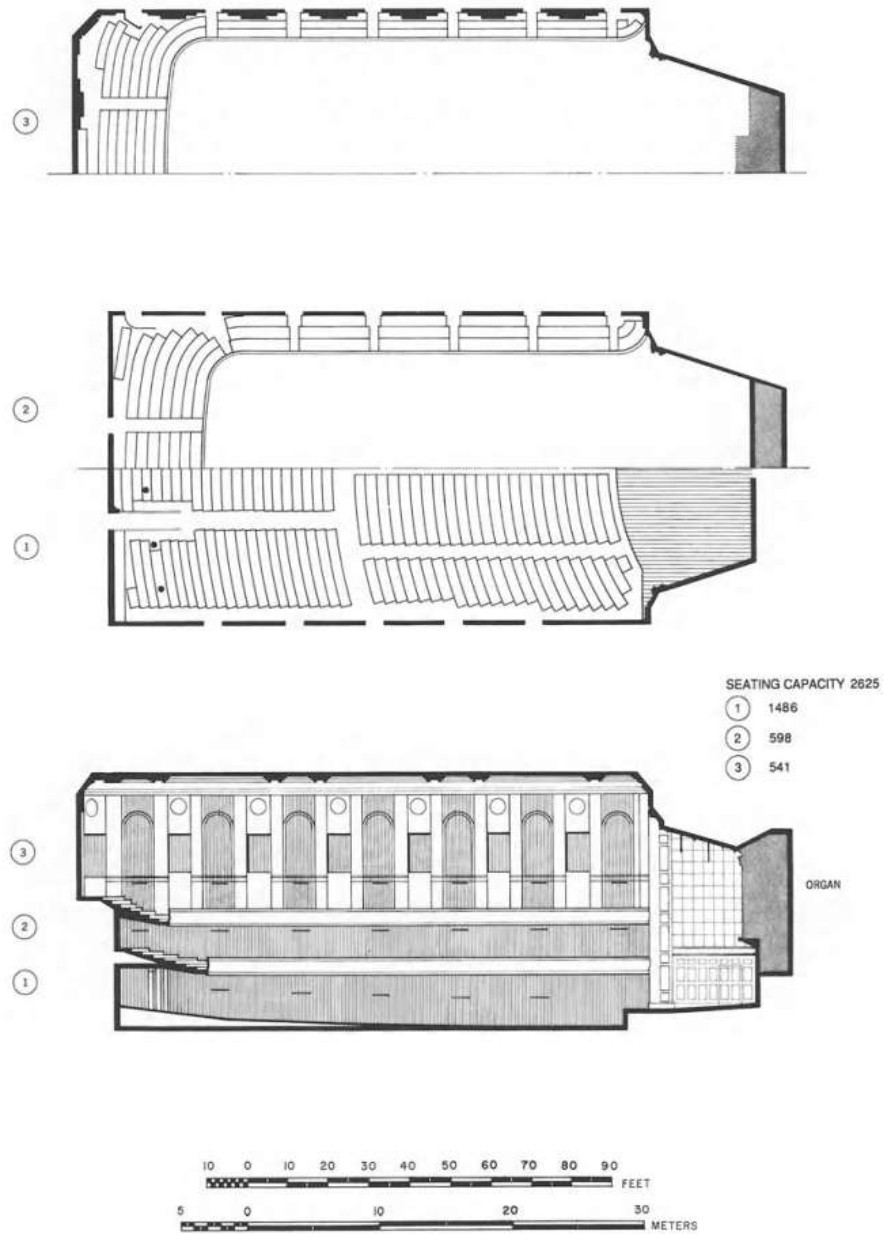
Grundriss und Seitenansicht Boston Symphony Hall [Beranek 2004, S. 49]
